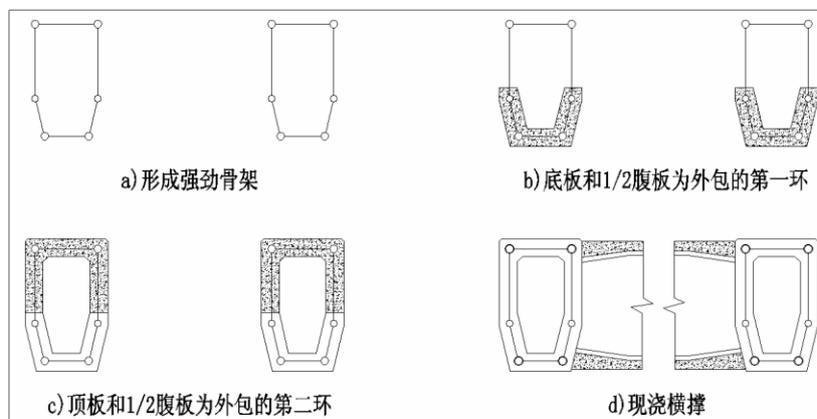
两环外包主拱混凝土的施工缝位置示意图 (2)
